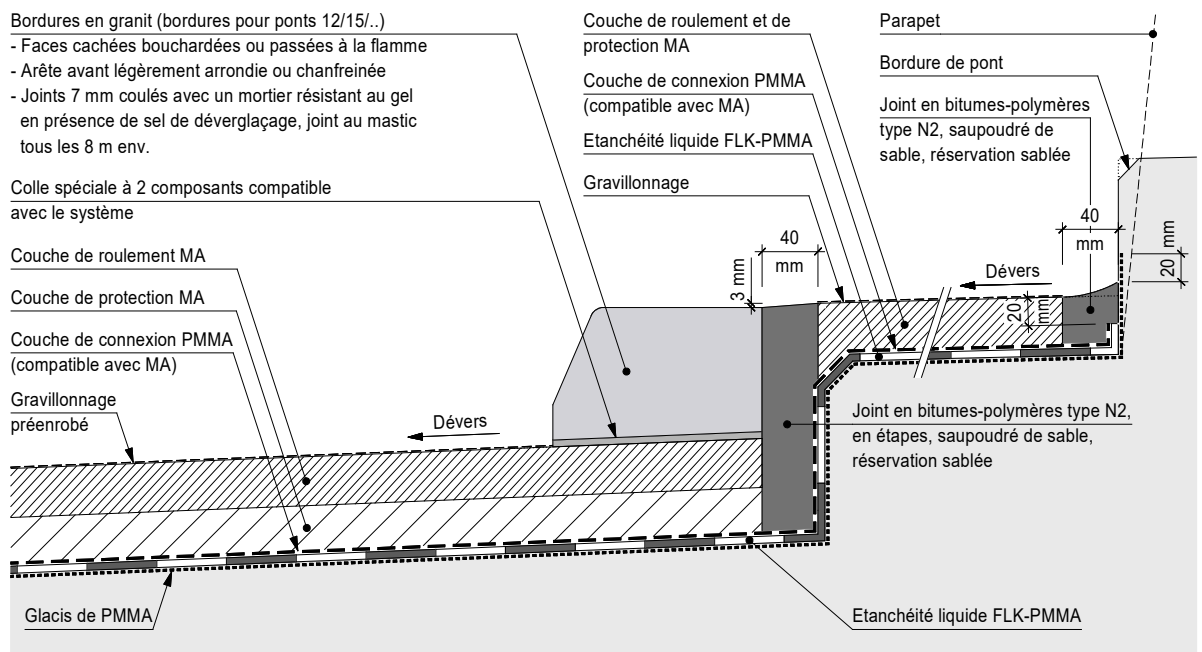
Système d'étanchéité FLK - Raccord aux trottoirs - Bordure de trottoir collée - Point haut
